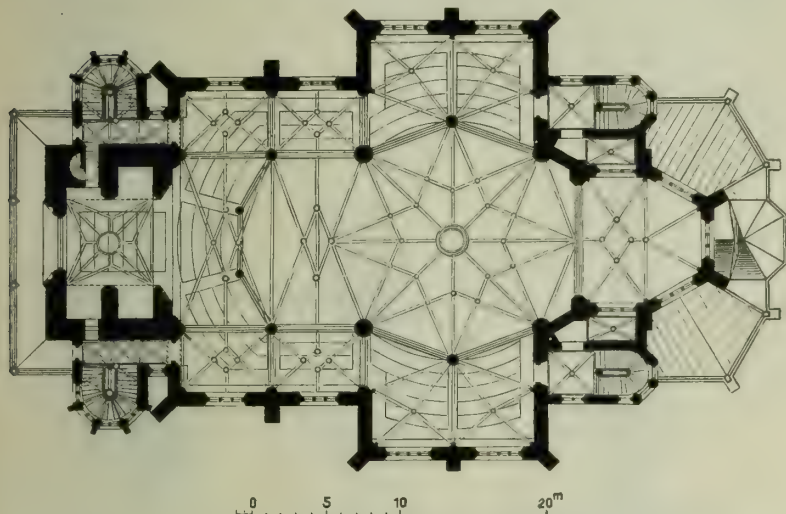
Grundriss in Höhe der Emporen.
